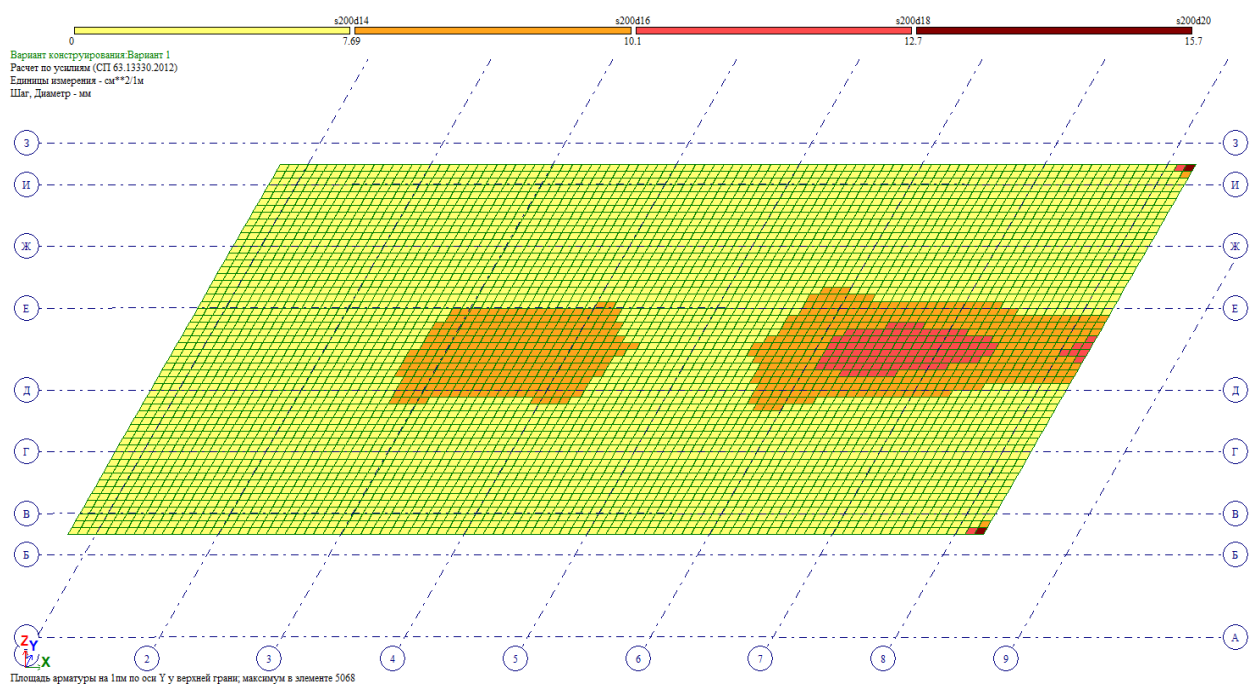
Площадь арматуры по оси У у верхней грани
